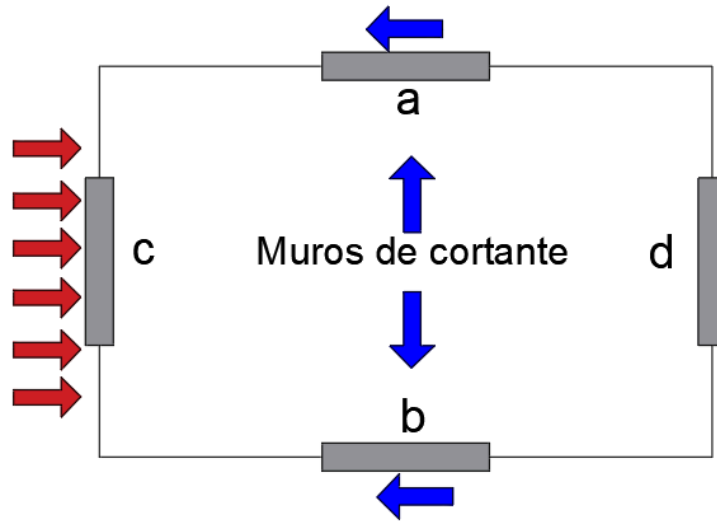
vista en planta de un piso soportado por muros de cortante / Fuente: (Brown & McCorman, 2011)
